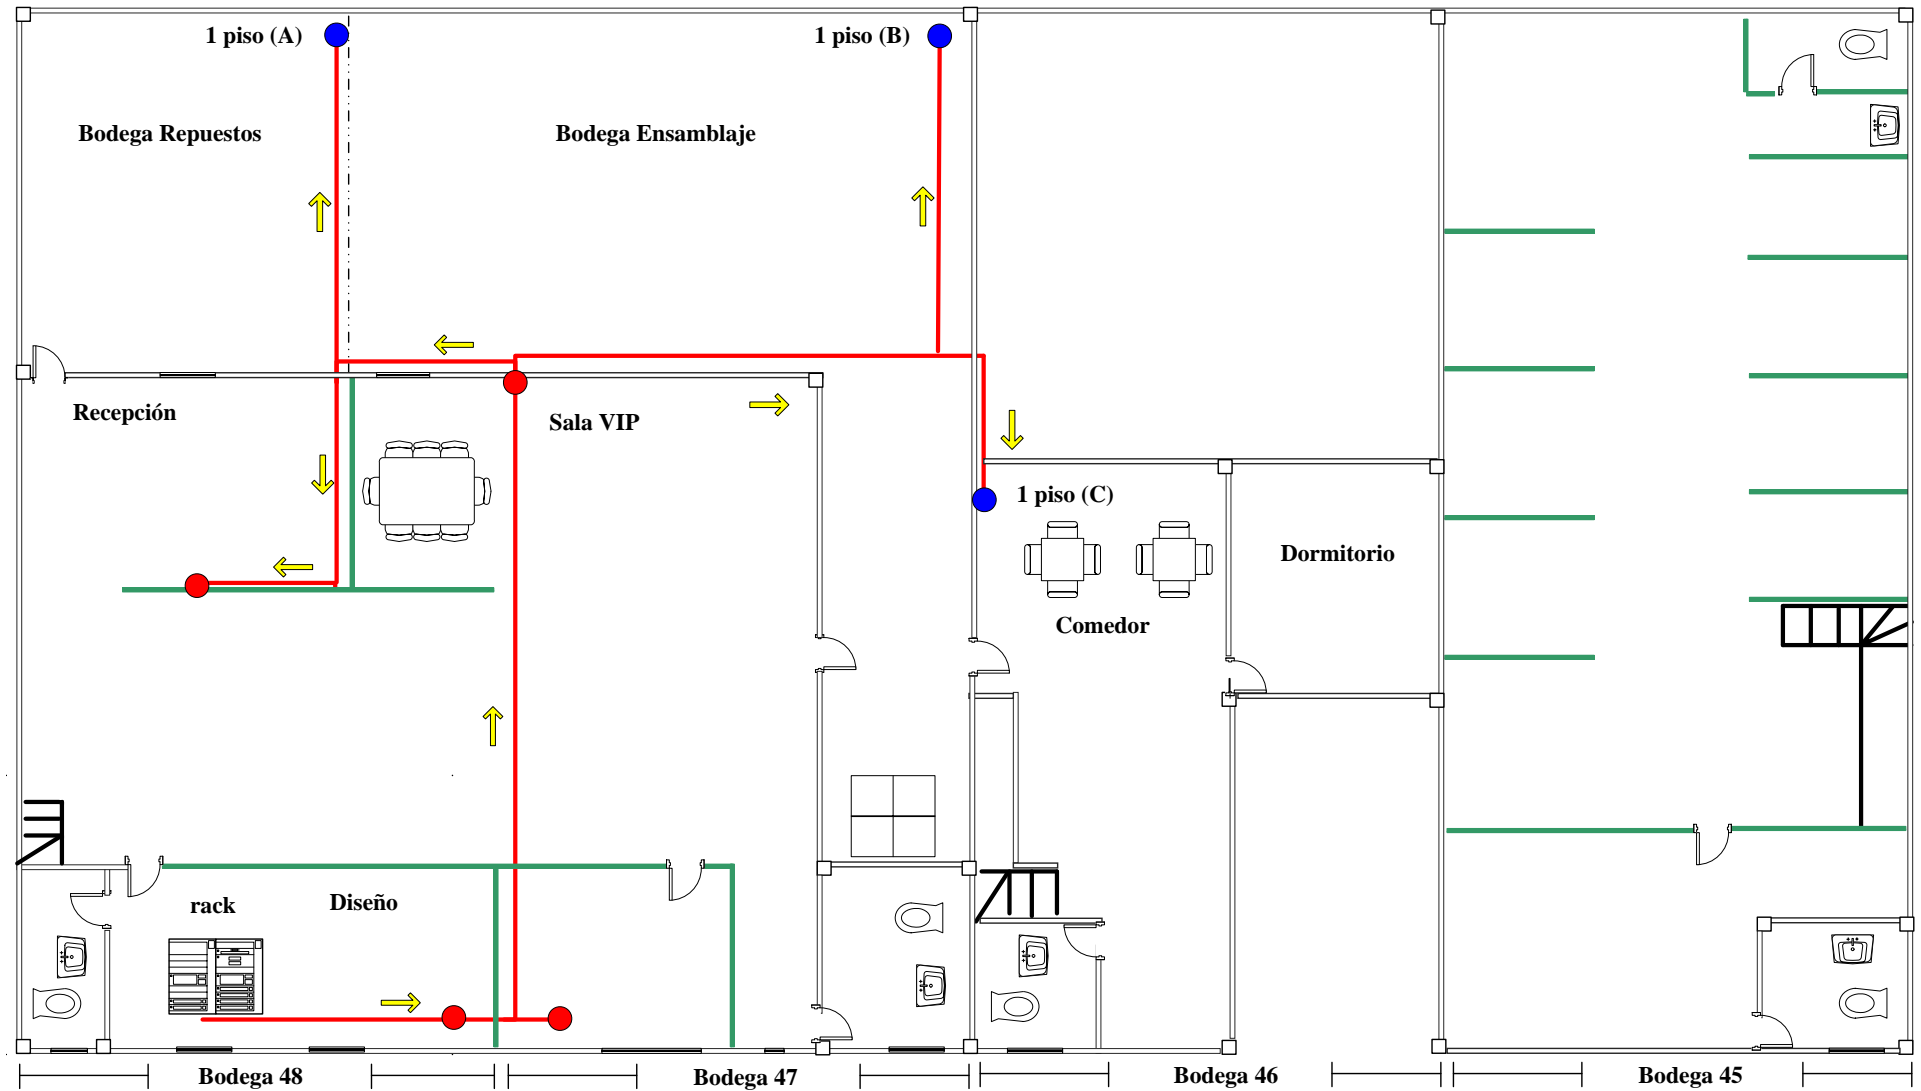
Planos de tendido del cableado estructurado segundo piso
